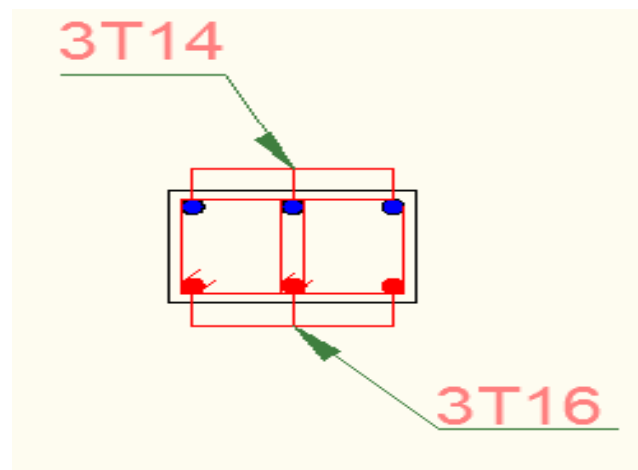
Schéma de ferrailage de la poutre de chaînage
